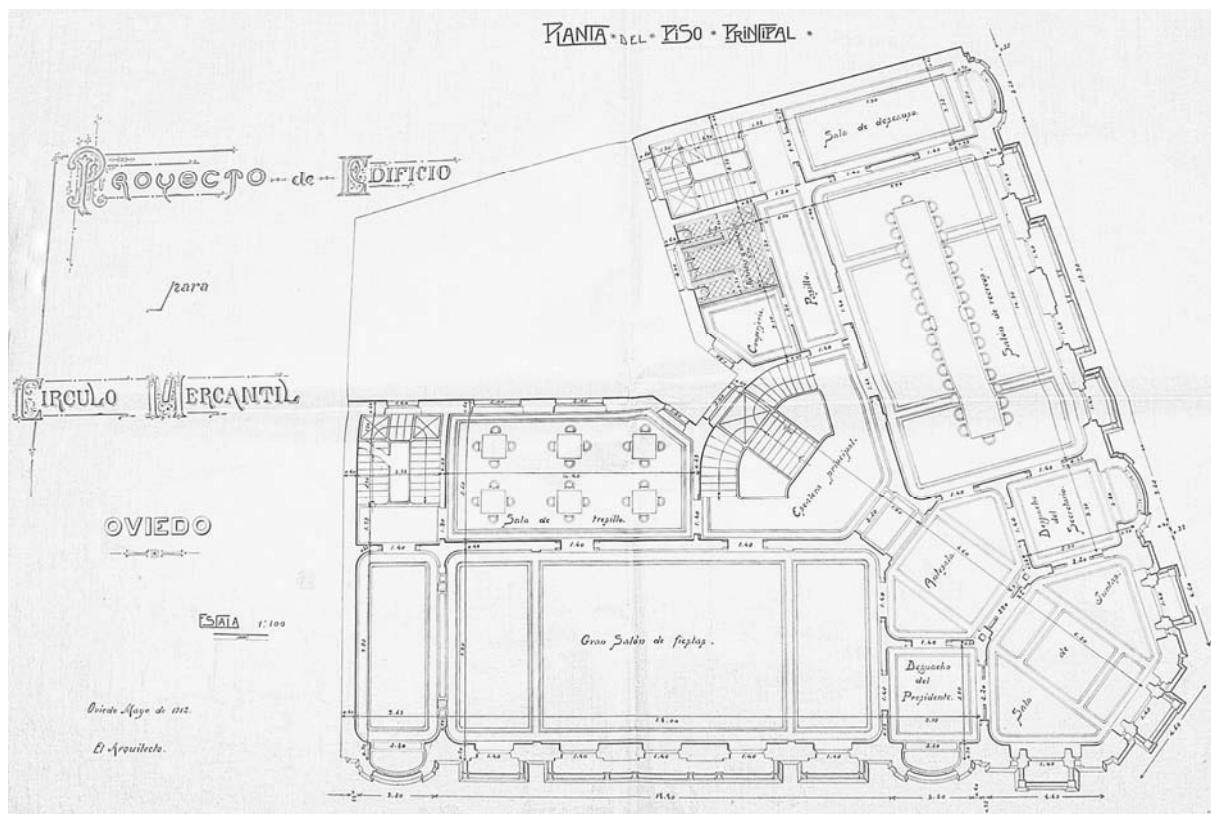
Plano de la planta principal del Centro Mercantil de Oviedo realizado en mayo de 1912. Archivo del Arquitecto Julio Galán Carvajal.
